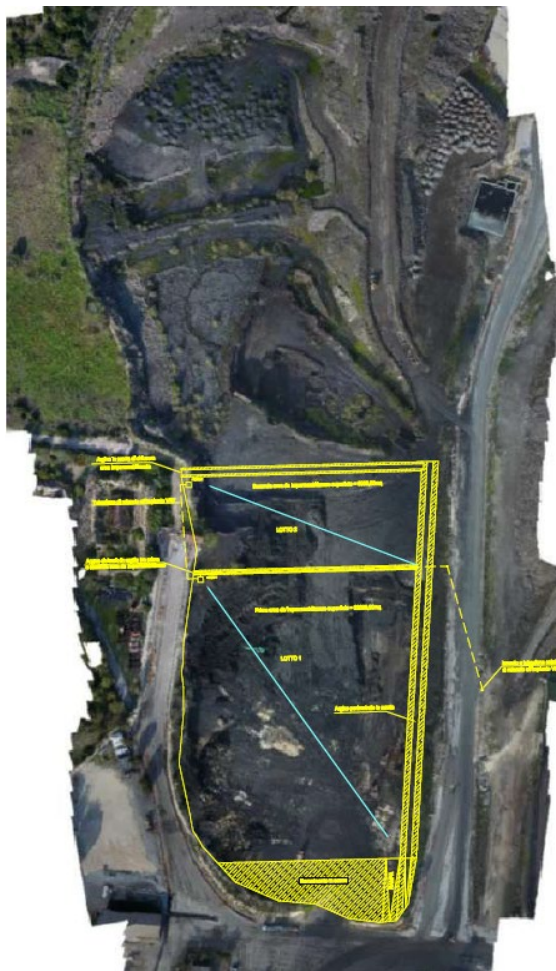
Delimitazione Area oggetto di intervento su Zona 2 – UP3.
